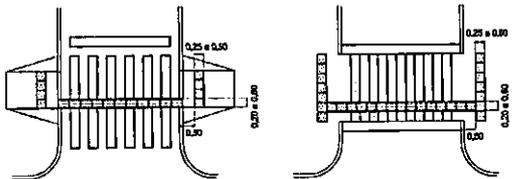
Rebaixamento de calçada com sinalização tátil de alerta e direcional - Exemplo
